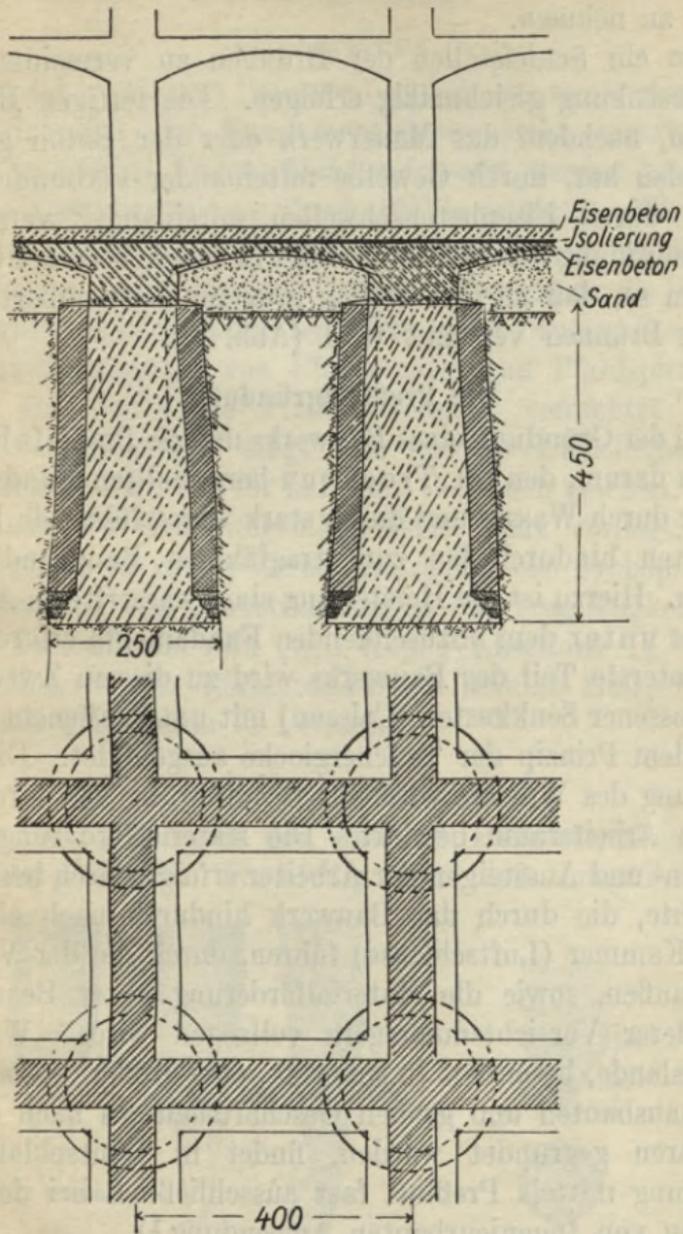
Brunnengründung im Grundriß und Schnitt.
